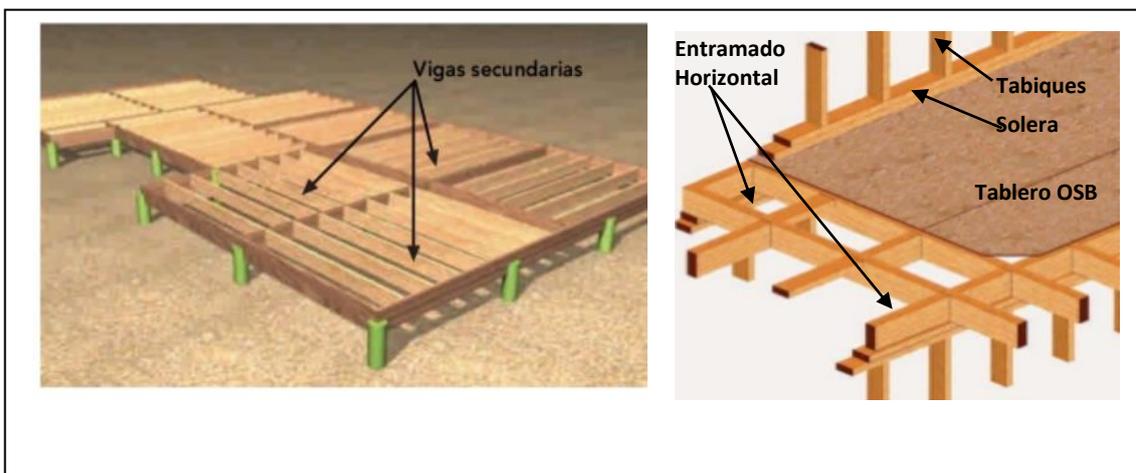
Entramado Horizontal para piso. Disponible en: Construcción de cabañas de madera.
